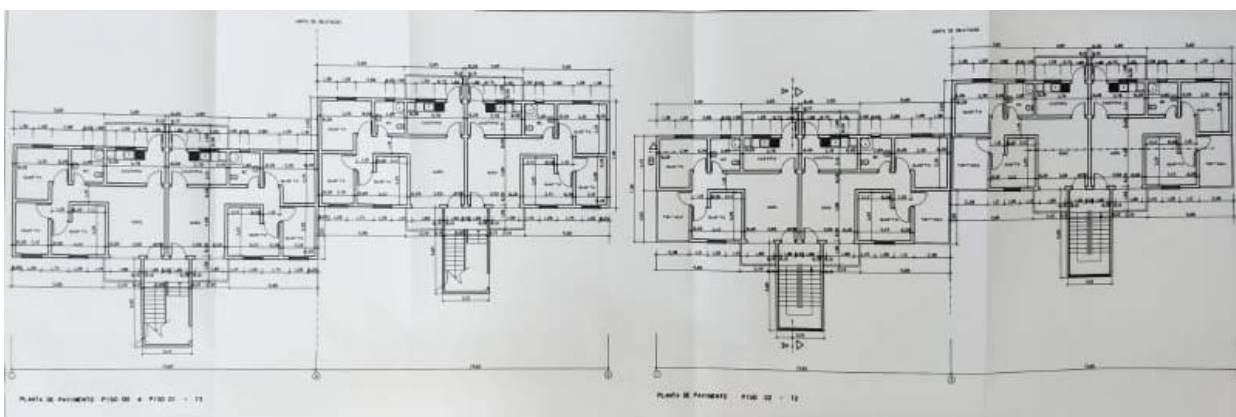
Planta dos pisos 0, 1 e 2 do projeto idealizado para execução no Campo de Milho. Desenho facultado pelo IHI
